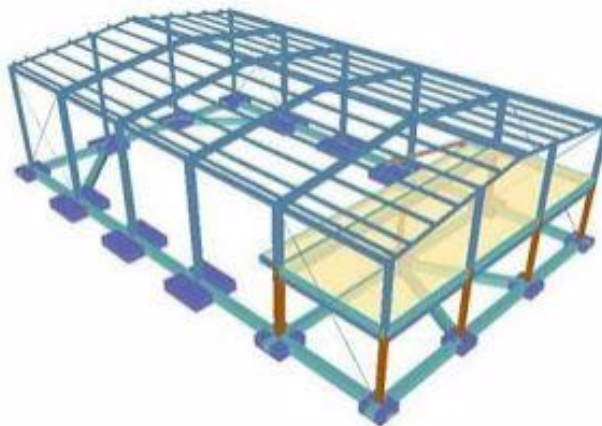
Pavilhão metálico de uma só nave [17]
